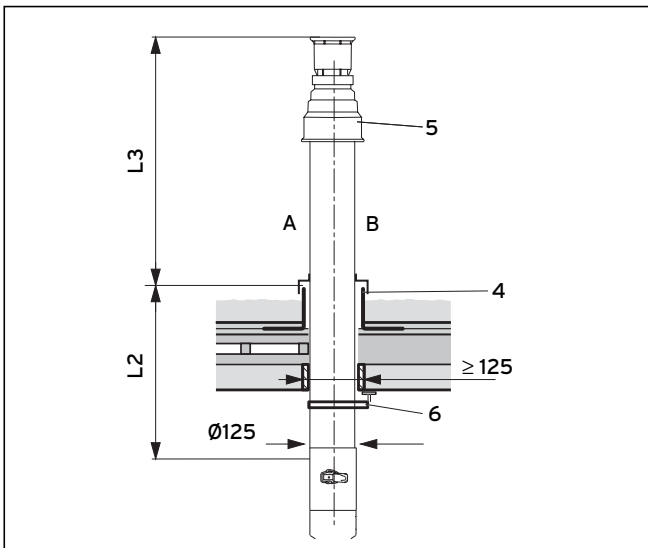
Montaggio del passante a tetto attraverso tetti piani
